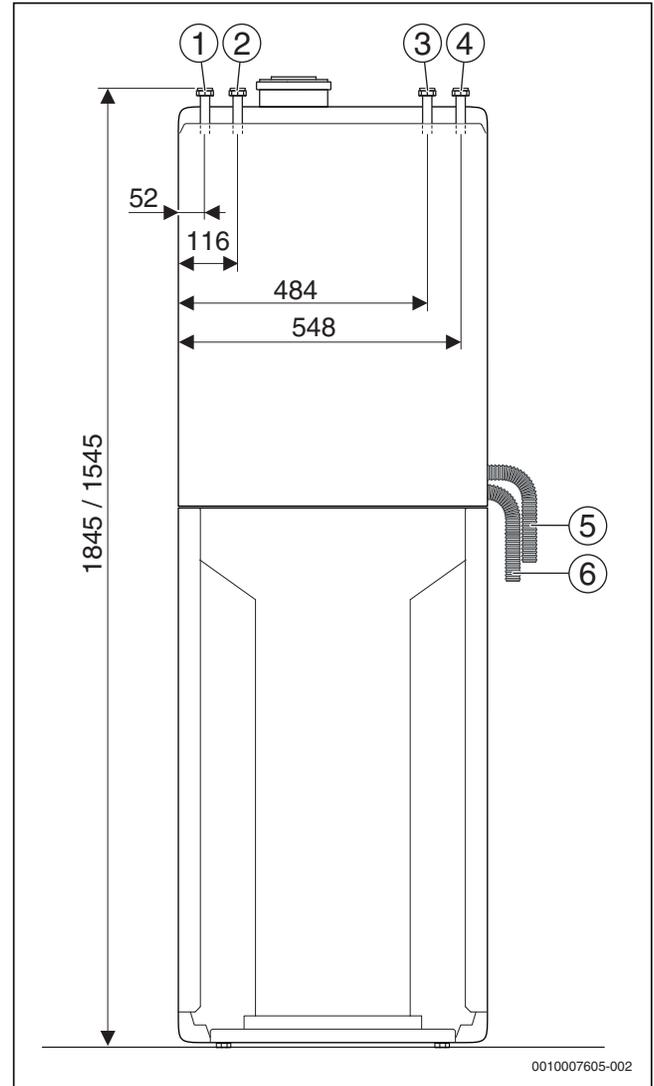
Anschlussmaße des Zubehörs Anschluss-Set solare Heizungsunterstützung SHU (Maße in mm)
